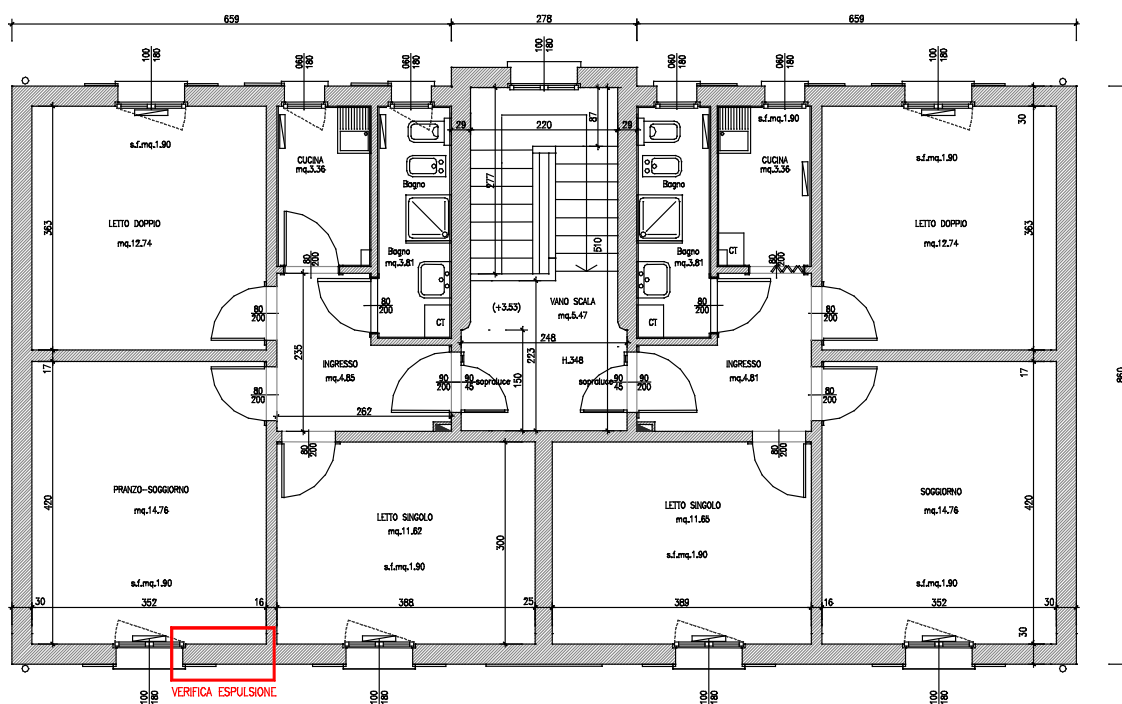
Palazzina B – PIANO PRIMO – Individuazione della parete oggetto di verifica
